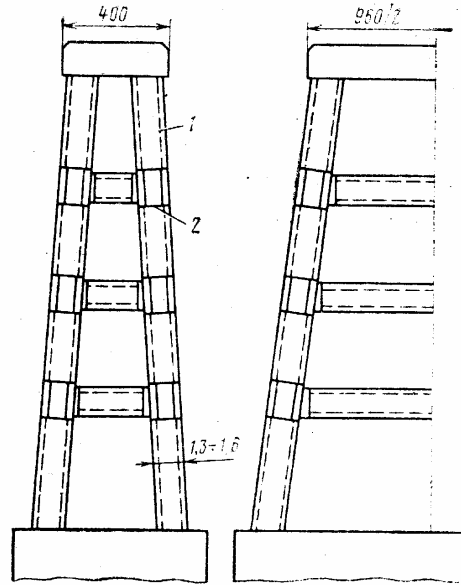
Козловая опора виадукa из центрифугированных железобетонных оболочек
